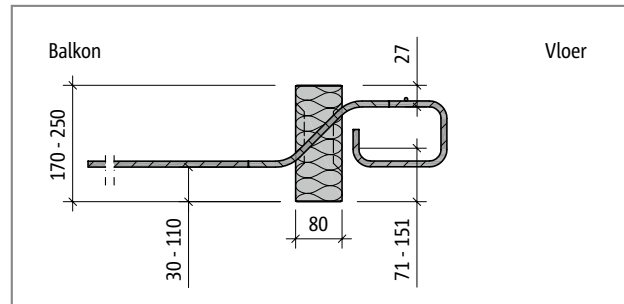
Schöck Isokorb® T type Q-E-V5 bij R0: Zijaanzicht
